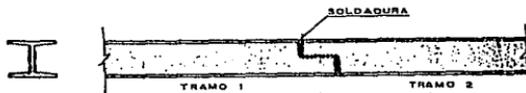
Soldadura de un pilote formado por un perfil estructural
